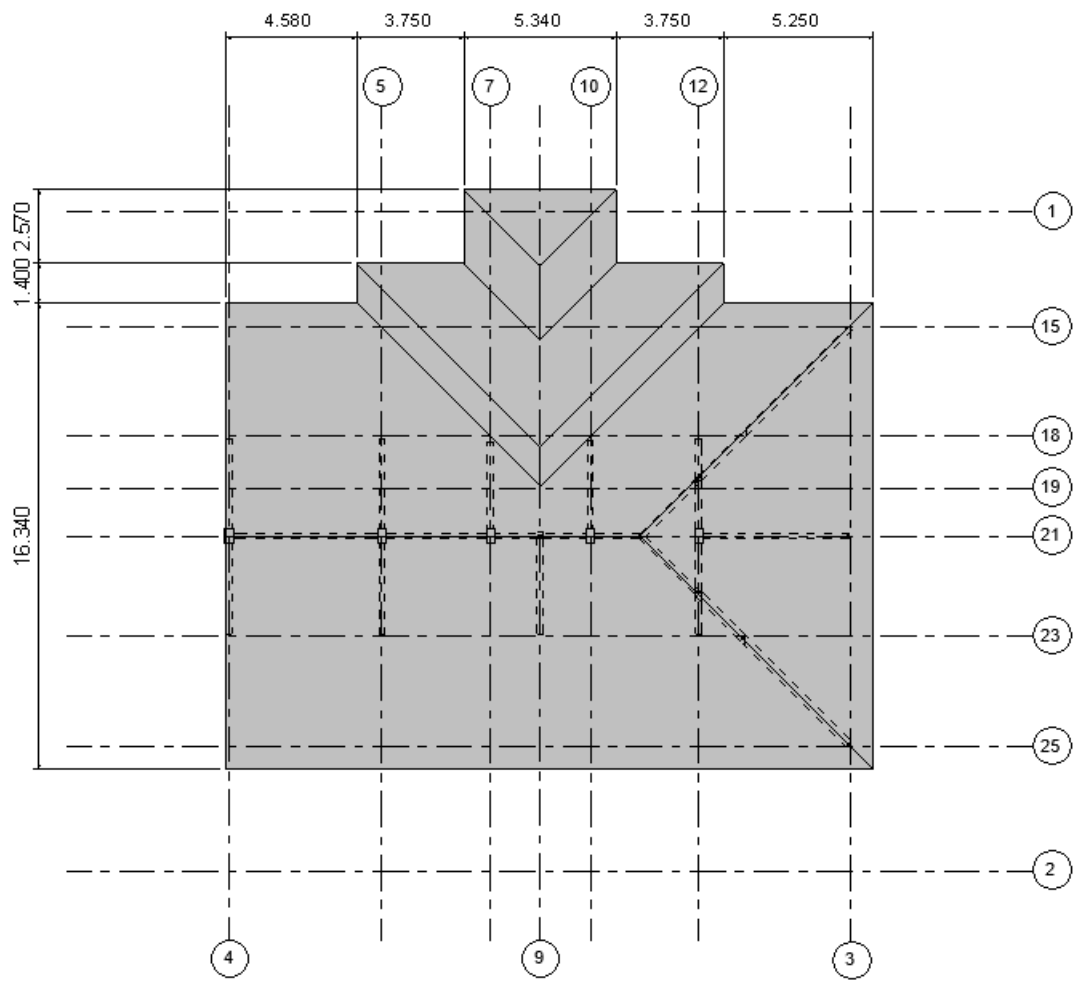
Planta estrutural da cobertura da solução estrutural 2 (Revit).
